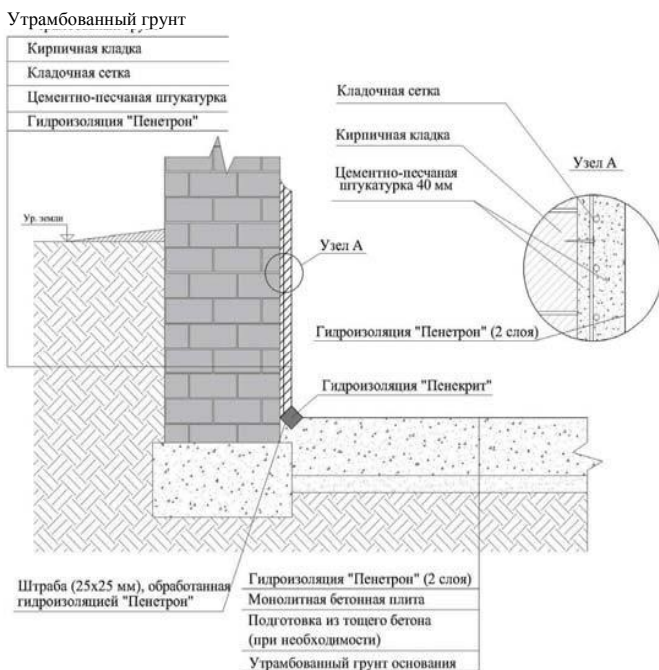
Устройство гидроизоляции по кирпичной стене изнутри помещения
